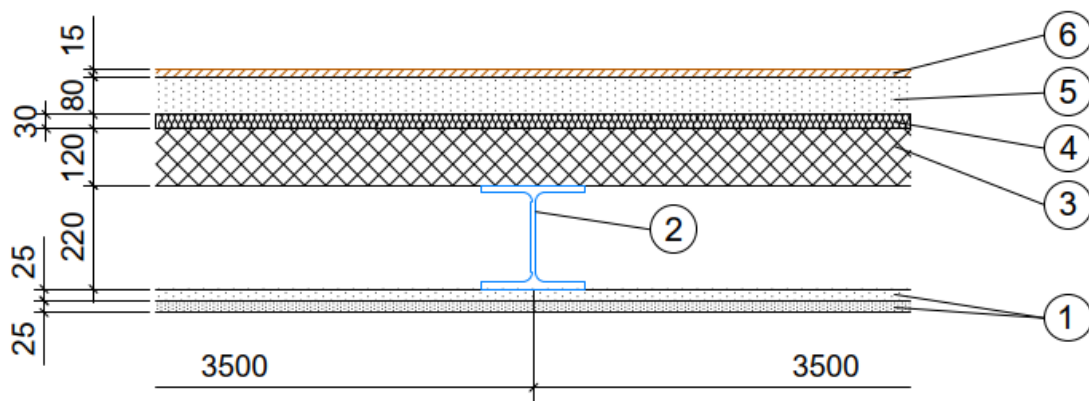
Aufbau Stahl-Beton-Verbunddecke
